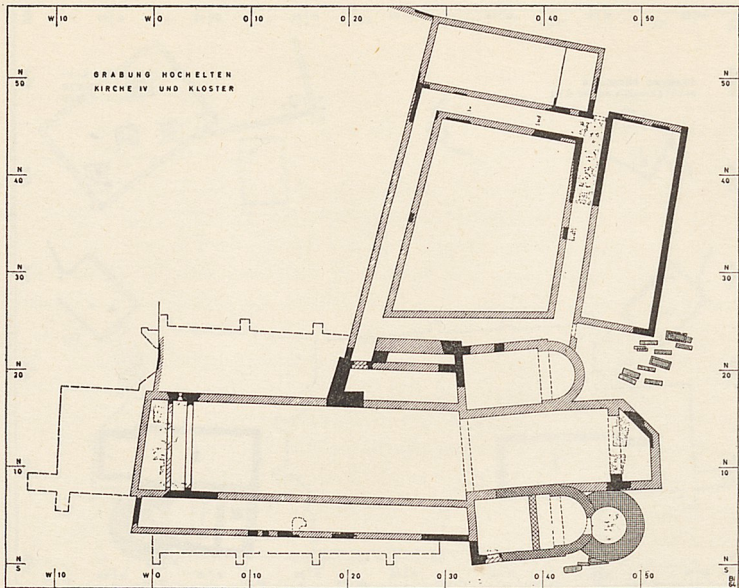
Abb. D Hochelten, Grundriß der ersten Stiftsanlage.
